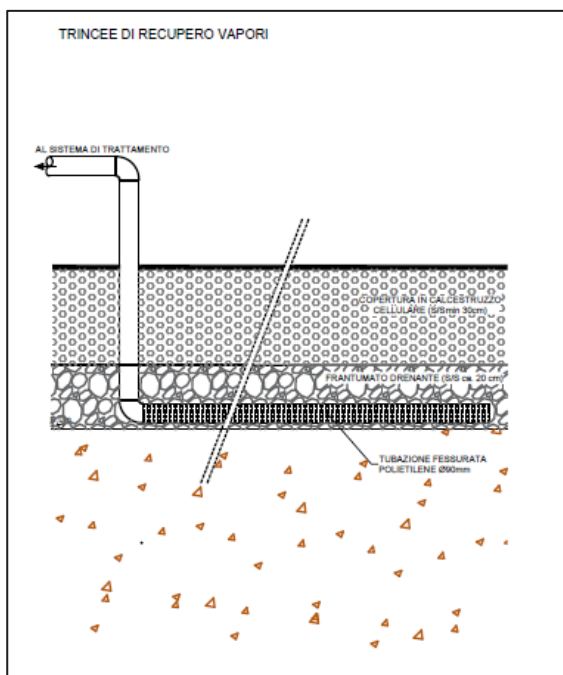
dettaglio di collegamento delle trincee di drenaggio
